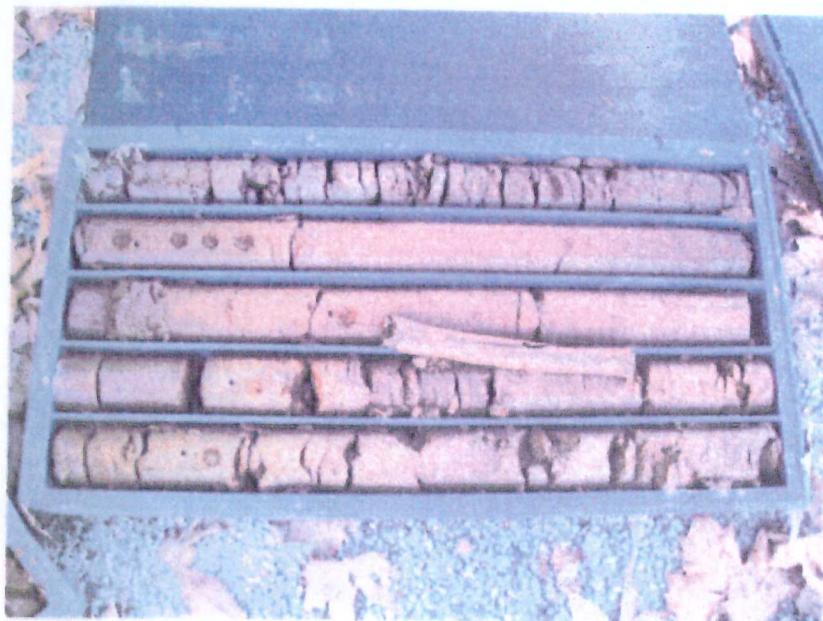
sondaggio S4 cassa 1 da m. 0.00 a m. 5.00
